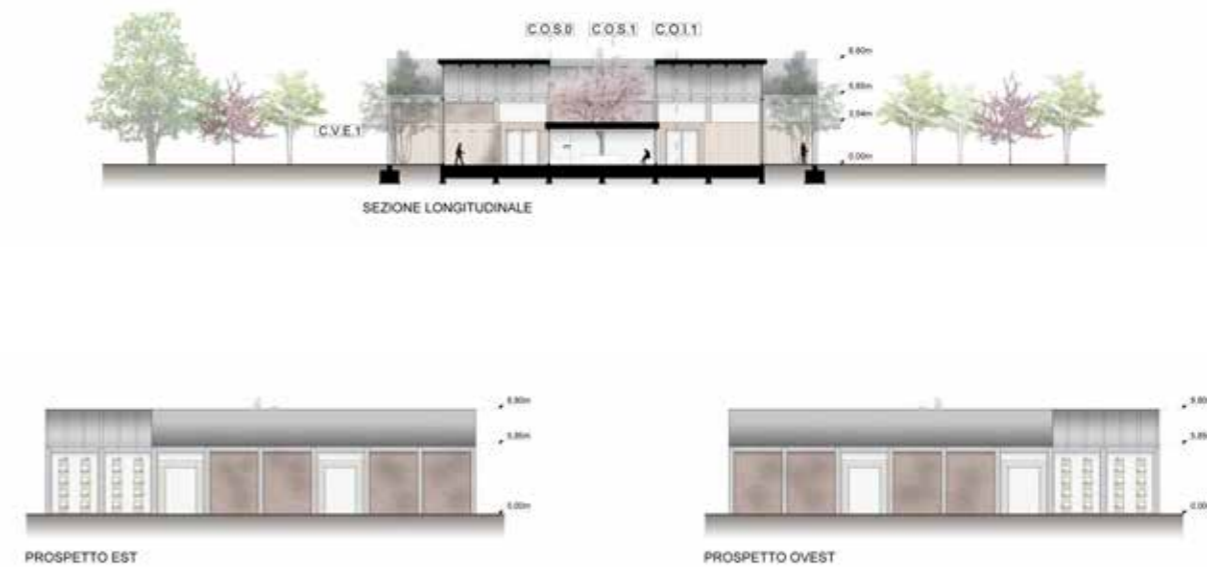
Sezione longitudinale e prospetti Capannone "AE"
